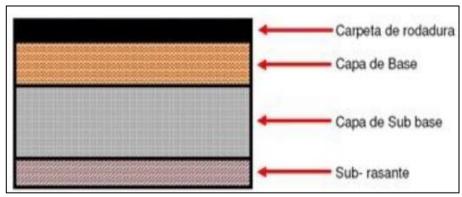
Estructura del pavimento flexible. Fuente: Paccori (2018).
